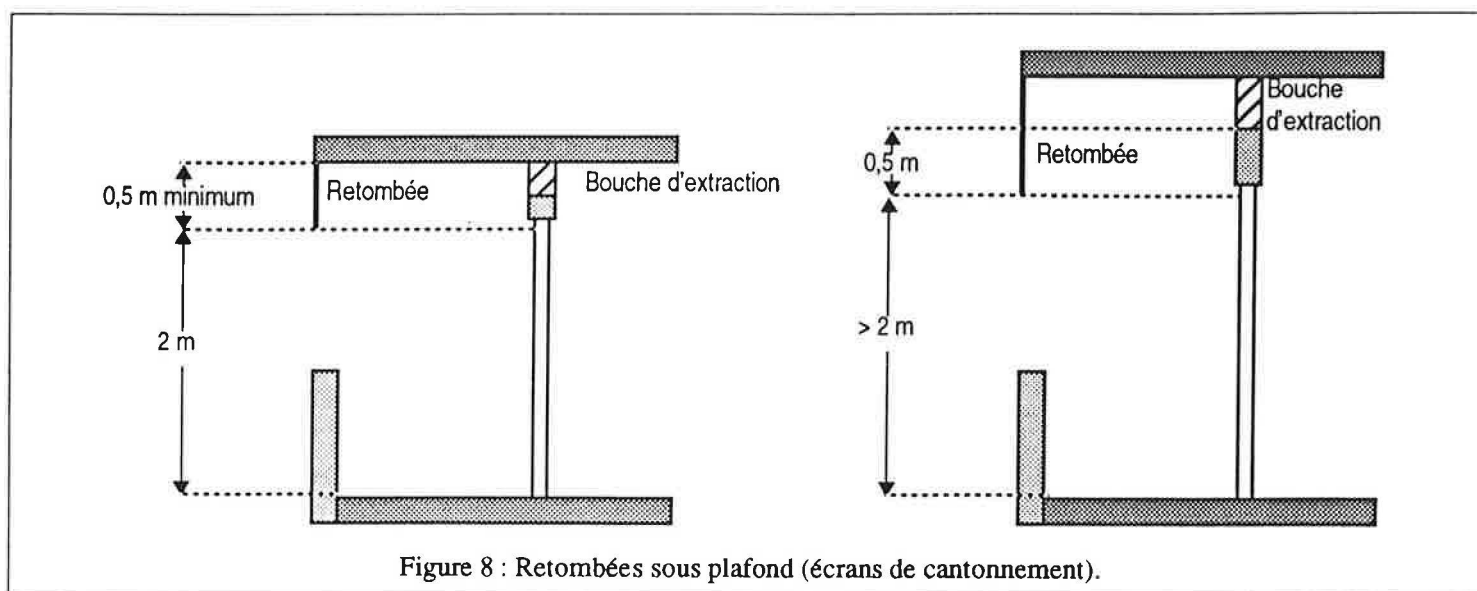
Retombées sous plafond (écrans de cantonnement).
